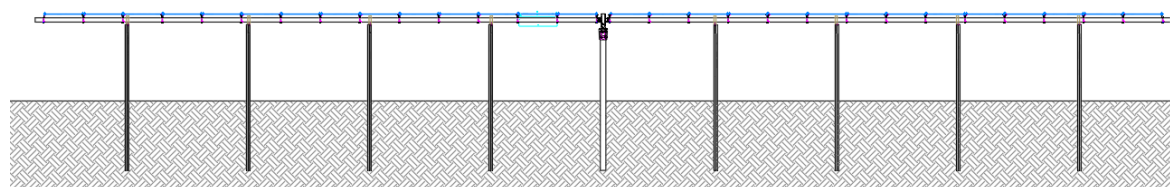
Schema della struttura di supporto – Sezione longitudinale
